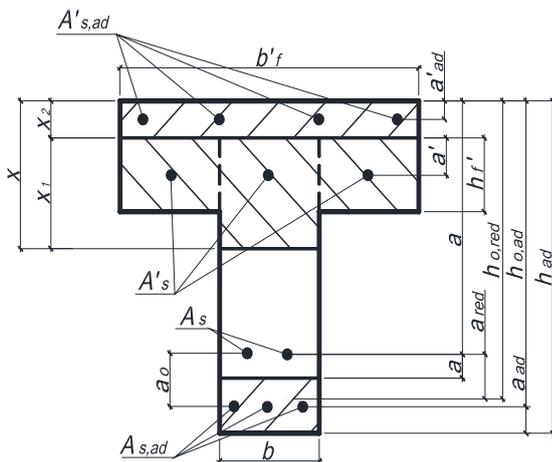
Расчетная схема усиления элемента таврового профиля по второму случаю ($x > h'_f$)
